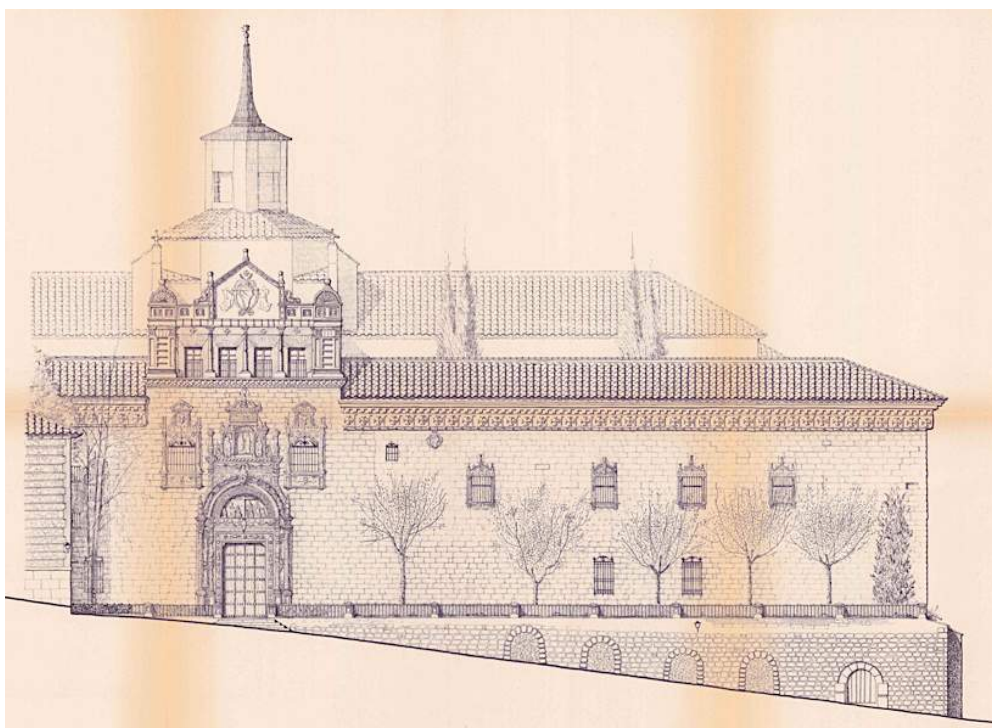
Hospital de Santa Cruz: Proyecto de restauración y acondicionamiento. Fachada, 1980.
